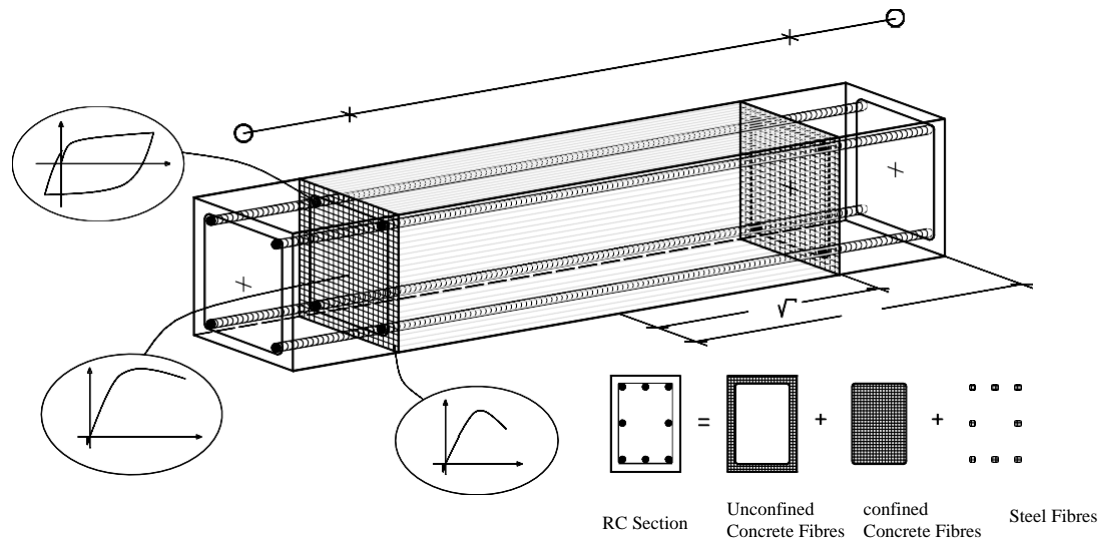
Modélisation des fibres d'une poutre en béton armé (Manfredi et al., 2007)
